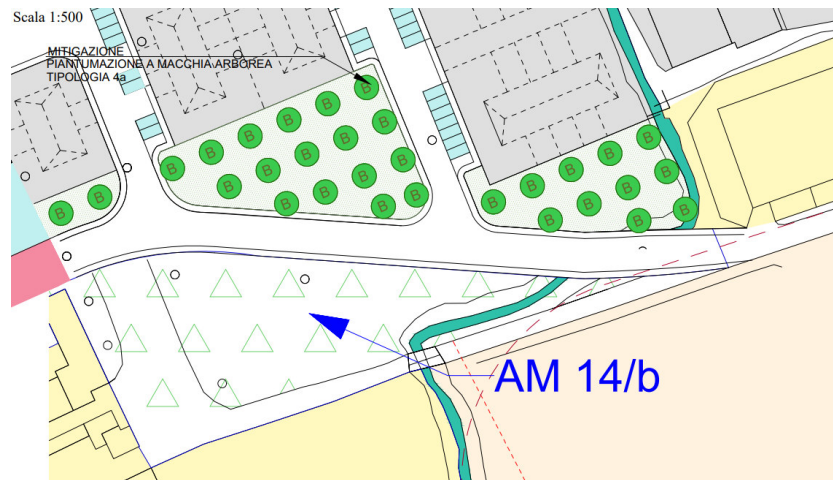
Estratto della planimetria di progetto delle opere a verde extra-comparto
